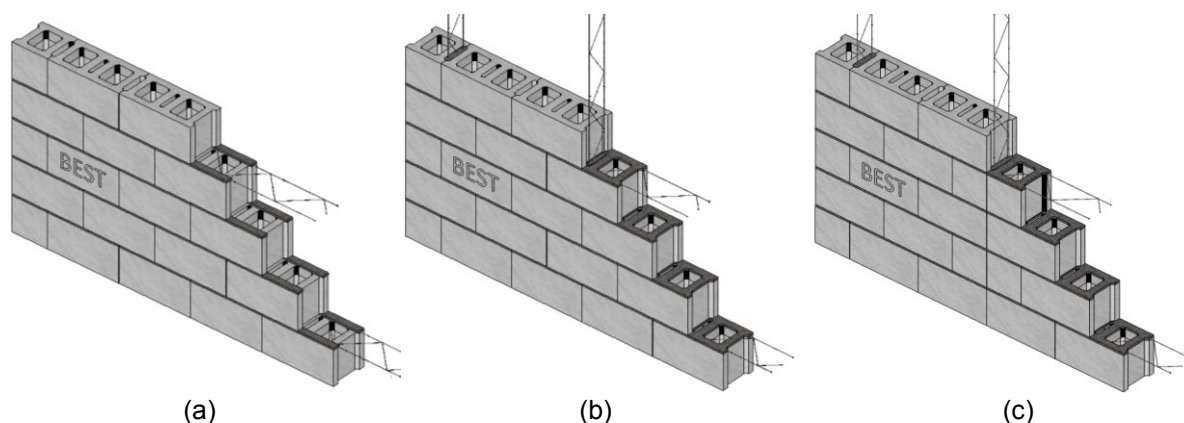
Detalhes do sistema construtivo em alvenaria armada; (a) armadura de junta; (b) aparelho tradicional com armadura vertical; (c) aparelho com junta vertical contínua
